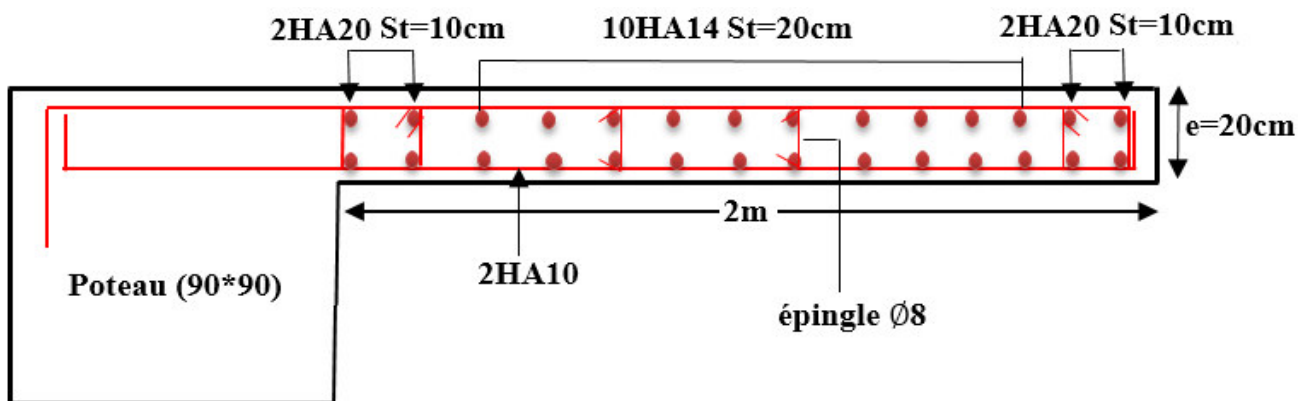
Schéma de ferrailage du voile V_{x2} pour les niveaux Sous-sol et entresol.
